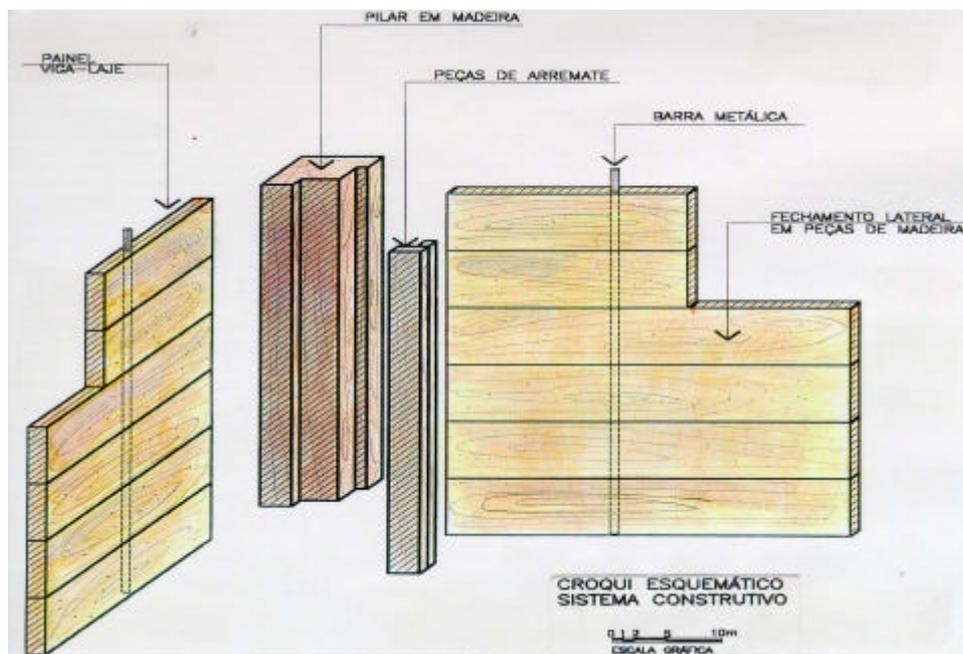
Detalhe do sistema construtivo com painel armado em madeira
